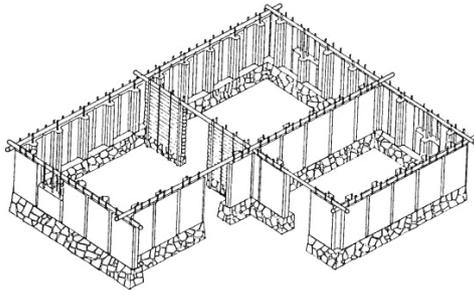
Vivienda realizada con este tipo de sistema constructivo. Cob y bambú interno. (Fuente: Gernot Minke).
